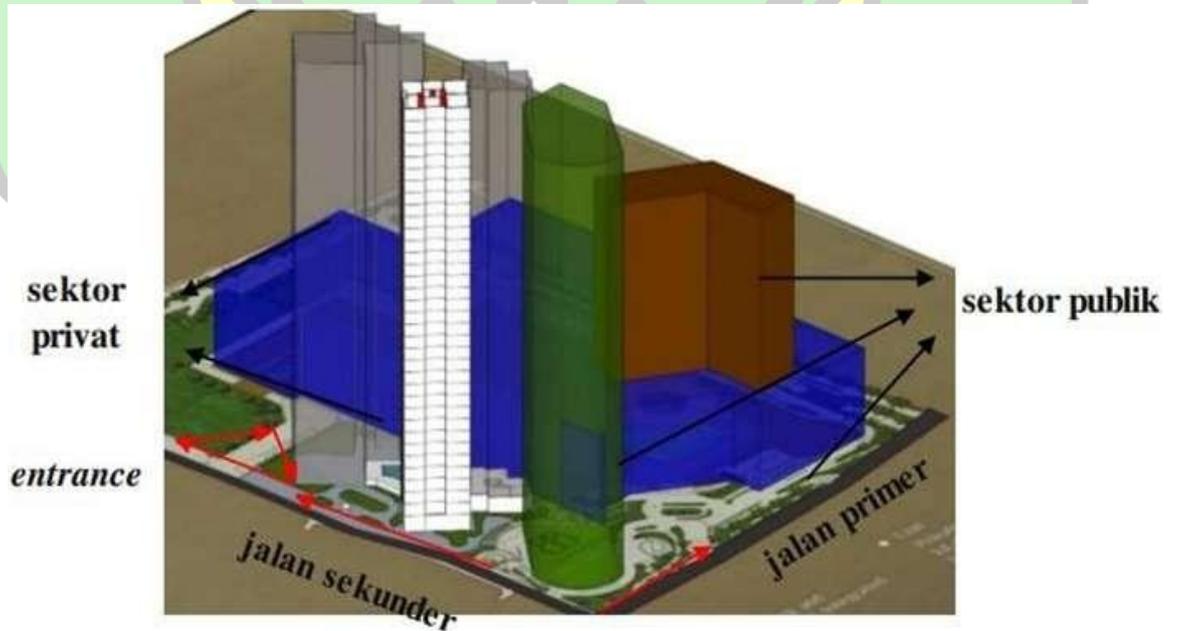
Site Plan Apartemen Casa Grande Residence
